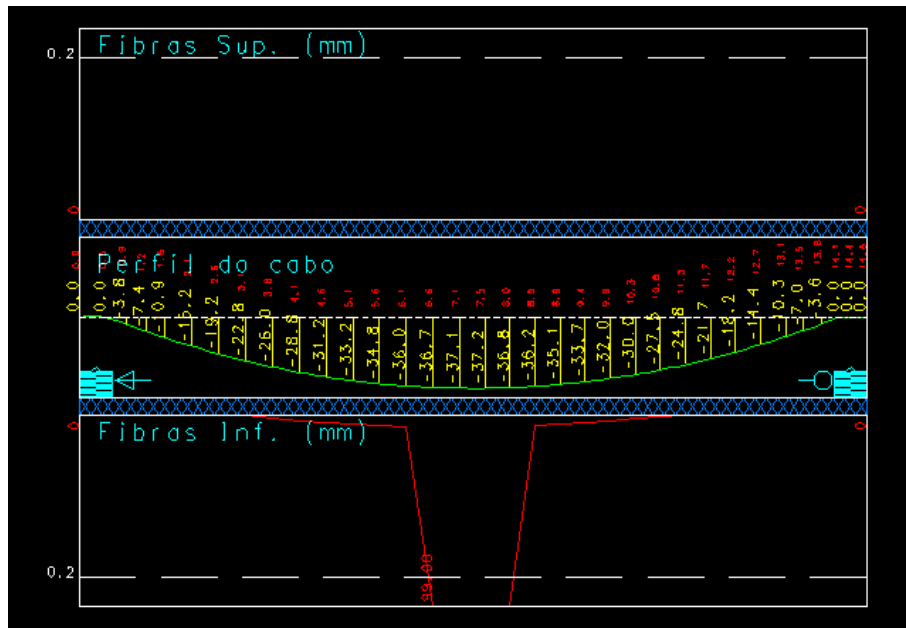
Fissuração viga V9 do 2º pavimento (CAD/TQS)
